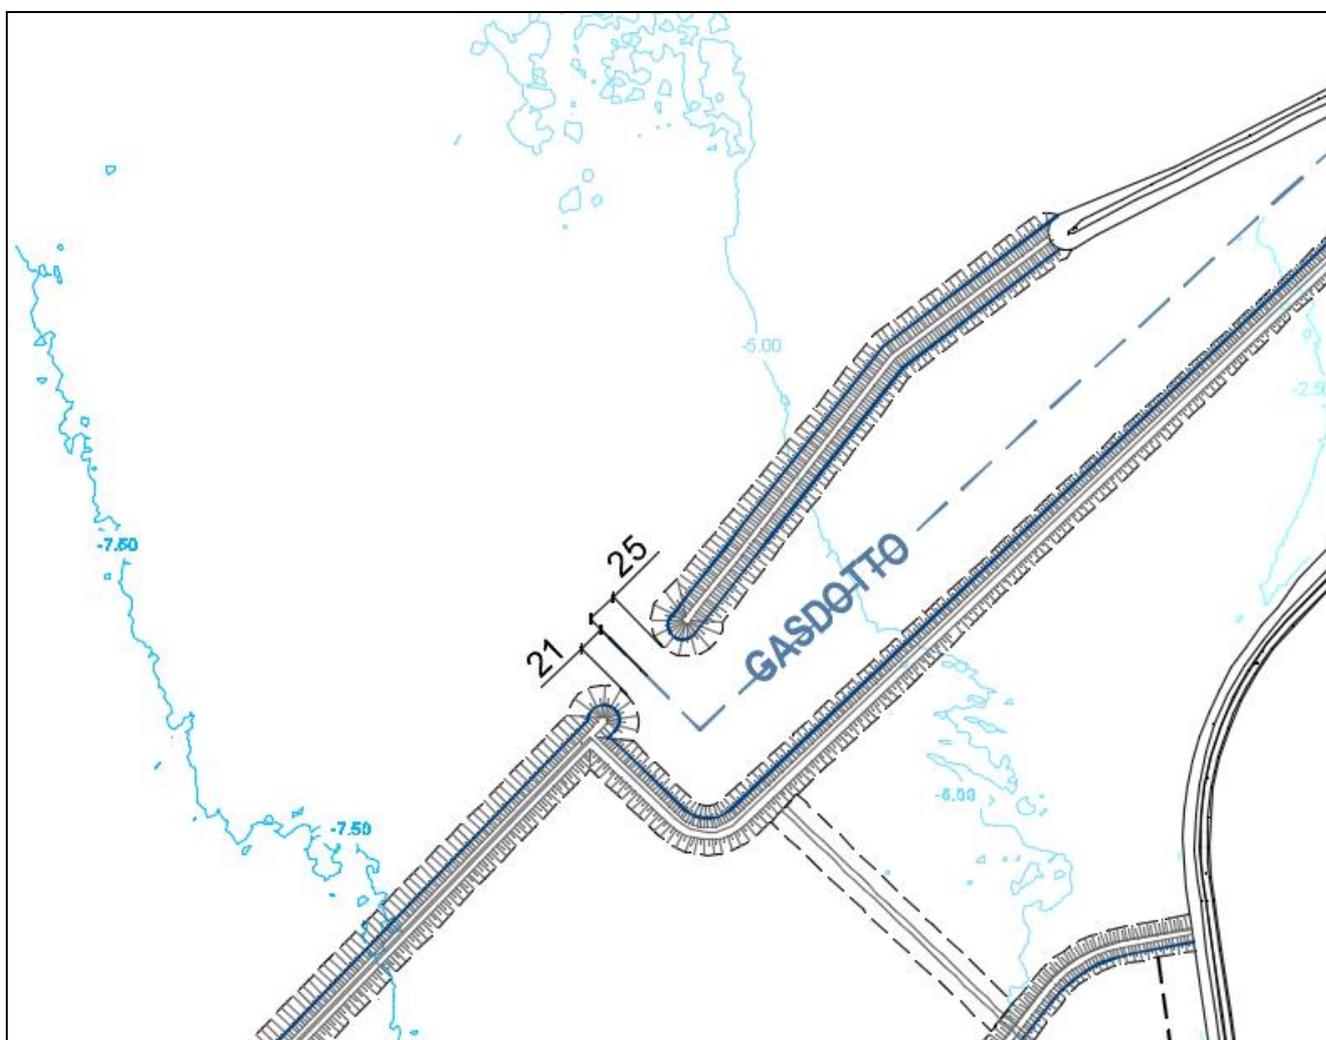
Layout di progetto in prossimità del gasdotto OLT
